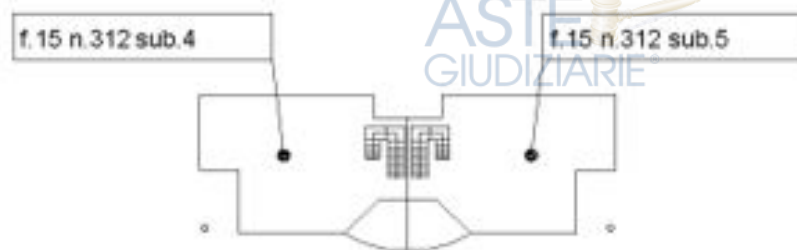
Elaborato planimetrico prot. n. TO0376726 – piano primo e secondo (sottotetto)
